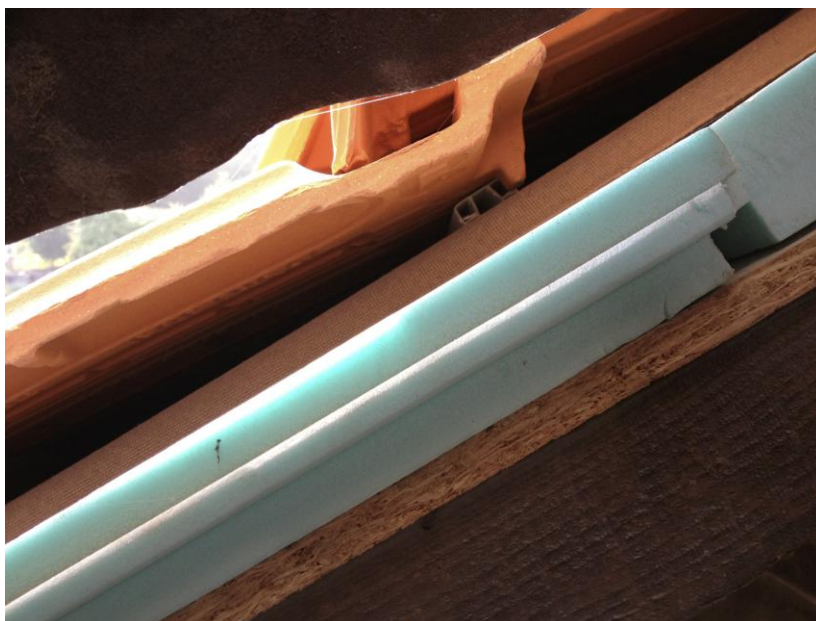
Perfil em estrutura metálica a reforçar a estrutura em madeira.
